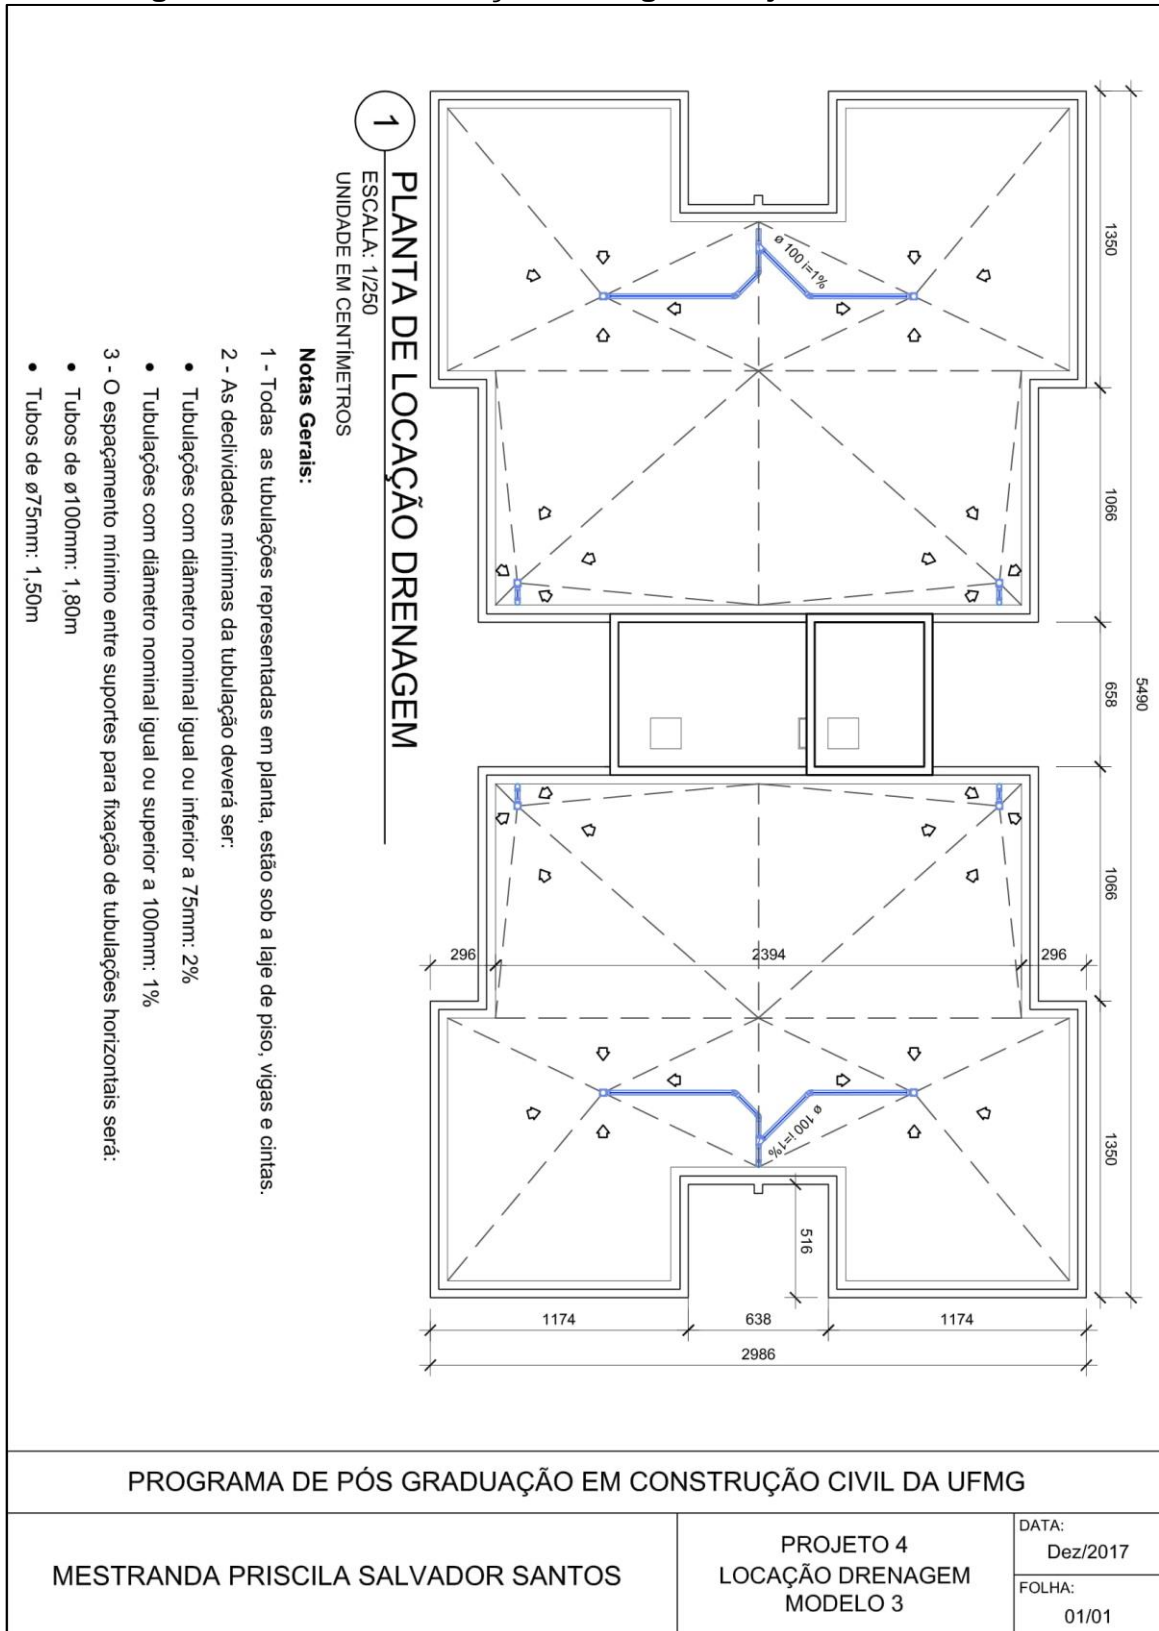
Planta localização drenagem Projeto 3 do Modelo 3
